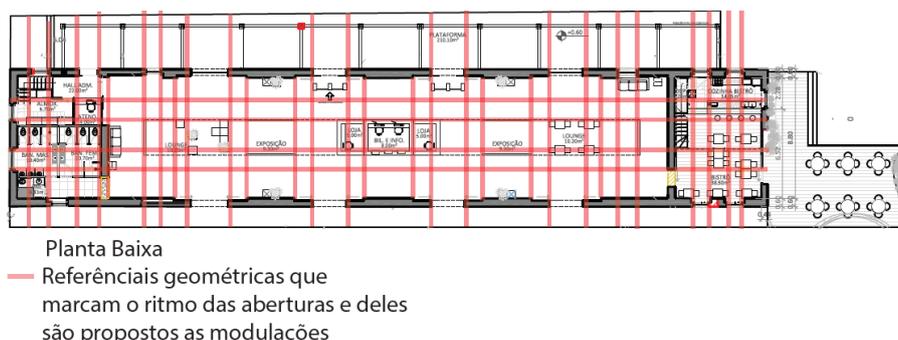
Modulação proposta para planta Baixa da Estação de Chiador. Da autora. 2019
